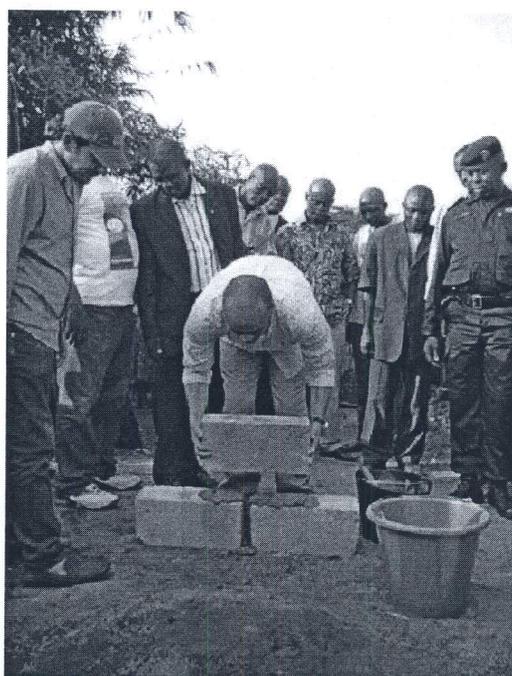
Pose de la première pierre du futur camp de travailleurs à Ingende - 30 juin 2011
